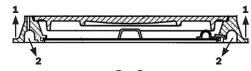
Детали корпуса чугунного люка лёгкого типа: 1 — фланец корпуса люка; 2 — кольцевая выемка в корпусе люка.
